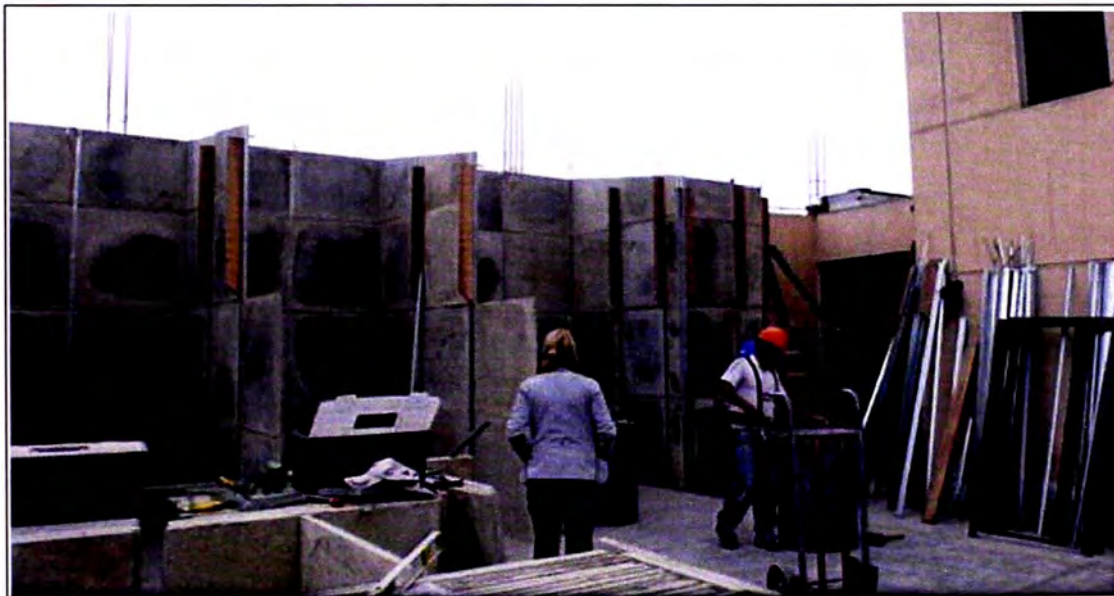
Instalación del sistema constructivo Viviendo Bien
